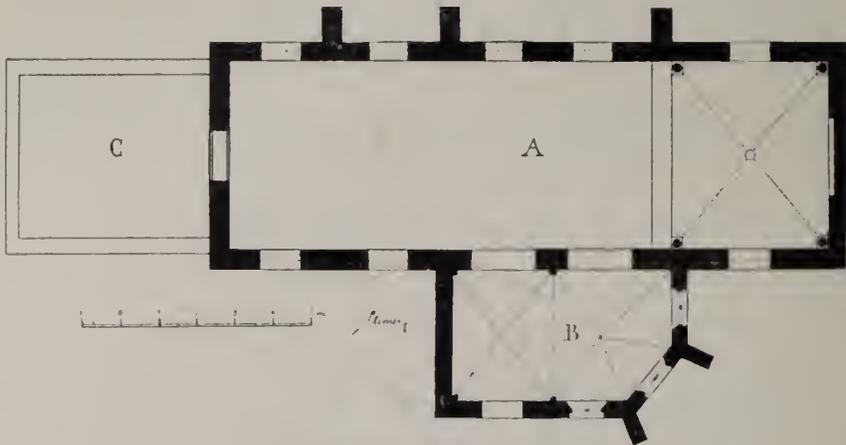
Kempen. Grundriss von S. Peter.
